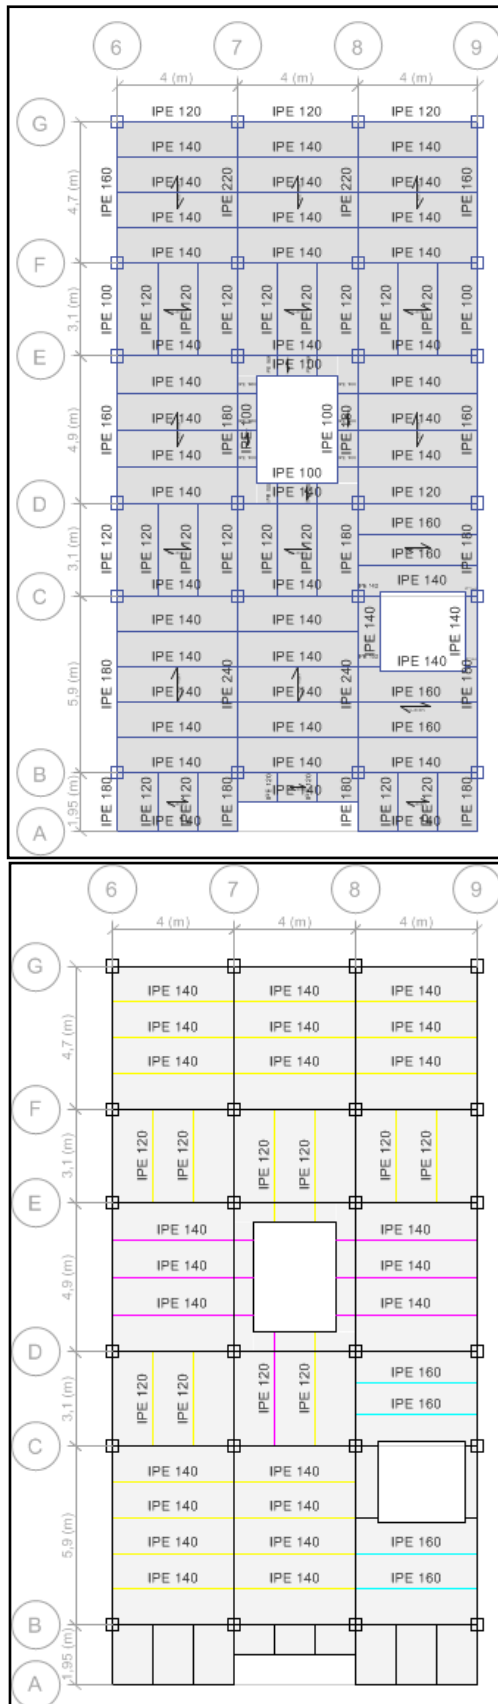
Demanda/Capacidad viga principal de planta alta bloque 2
